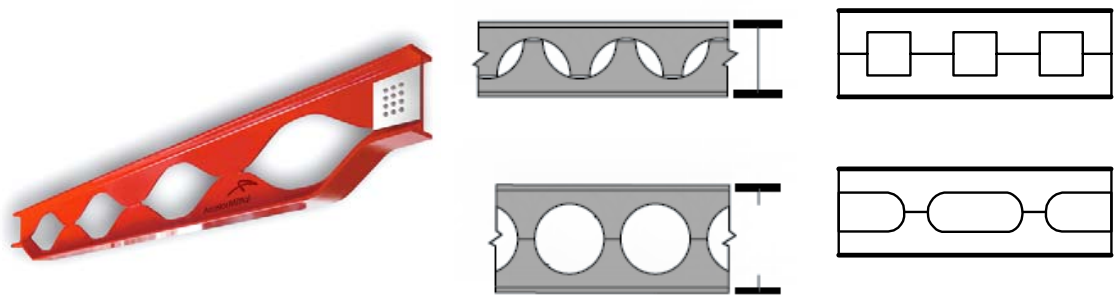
Processo de corte e soldagem de vigas alveolares.
